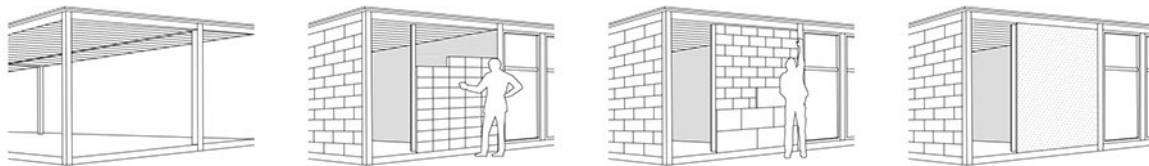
Acciones transformadoras del usuario sobre el soporte o estrategia: a) estructura base, b) muro aparente, c) muro de piedra y d) muro aplanado. *Casas que crecen* de Pedro Ramírez Vázquez
